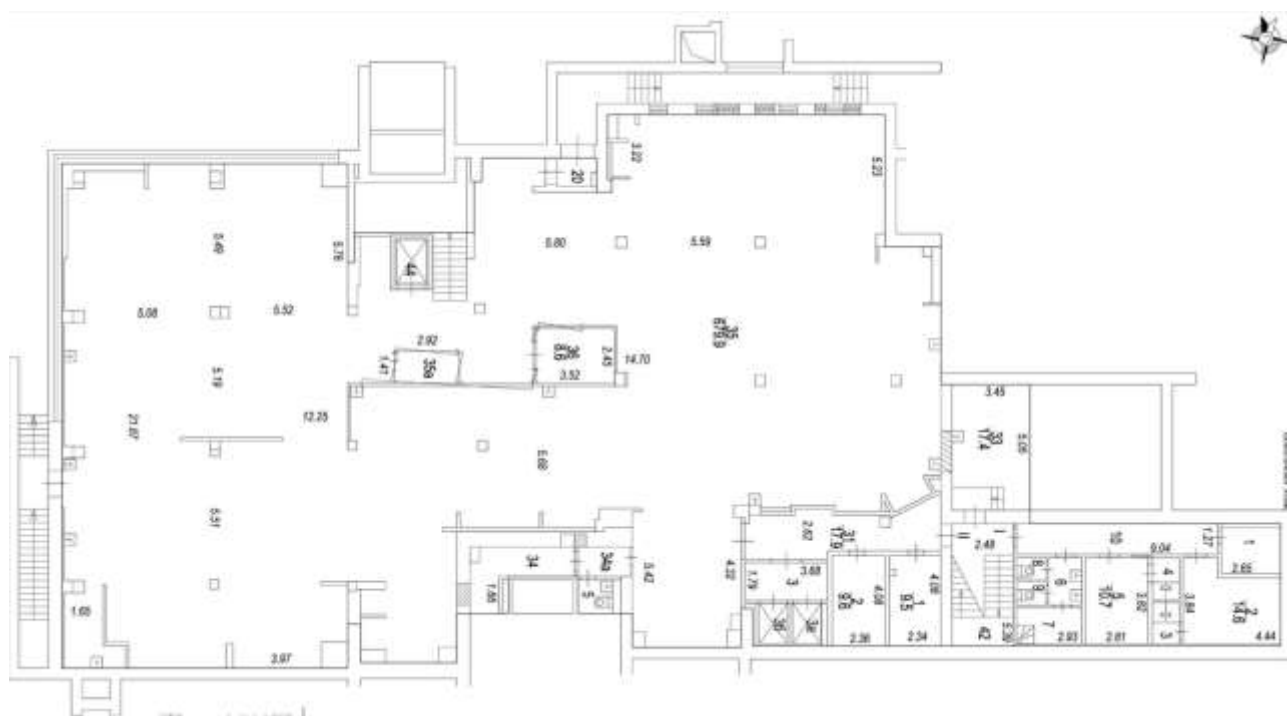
Схема оцениваемых помещений на поэтажных планах (цоколь)
